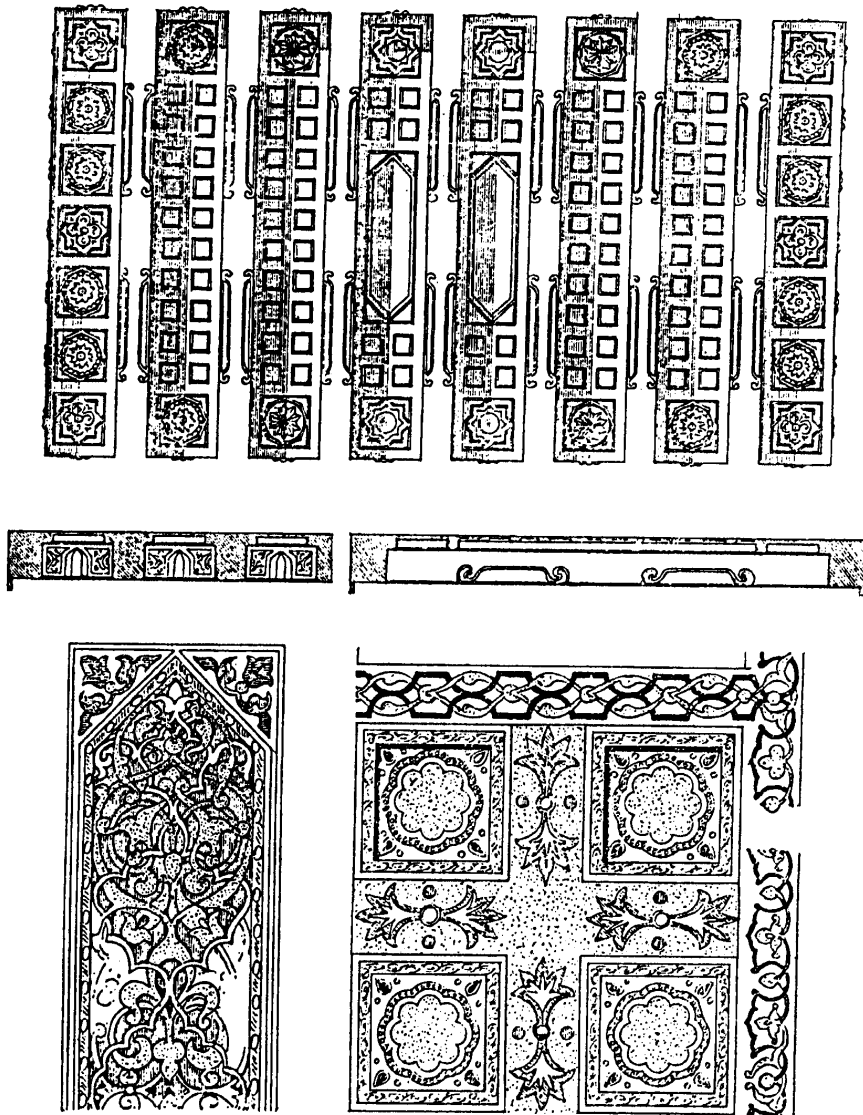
مسقط أفقي لأرضية رخام بحدخل محل (تصميم المؤلف)
